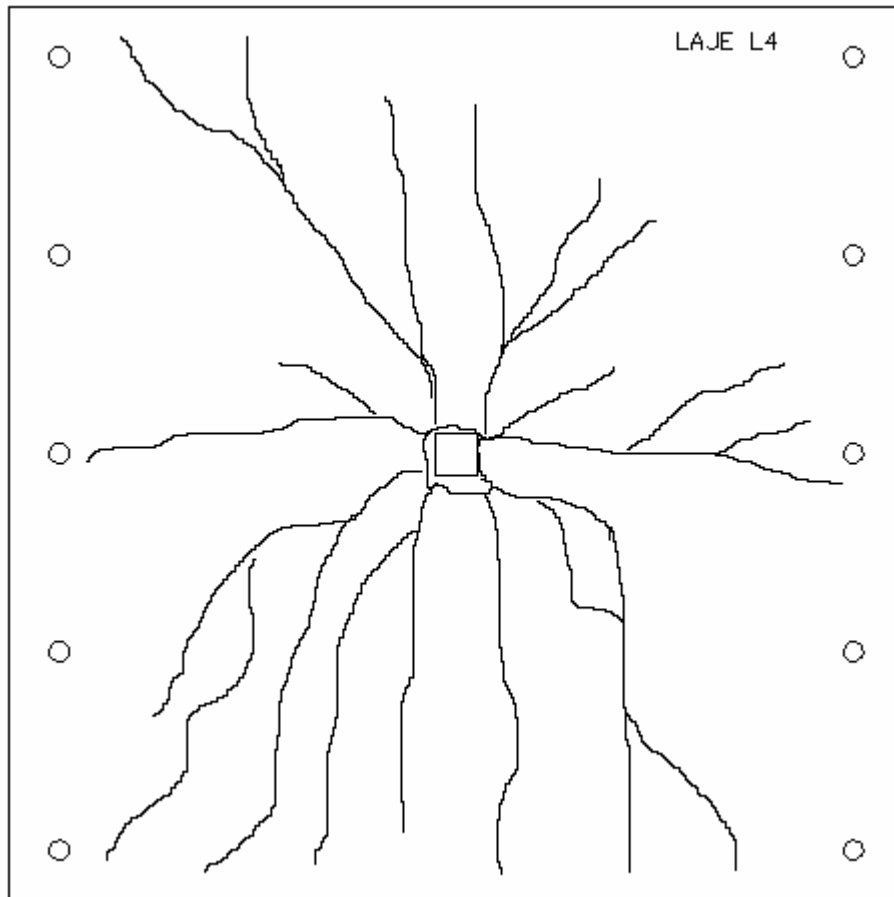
Mapa de fissuração da laje L4
